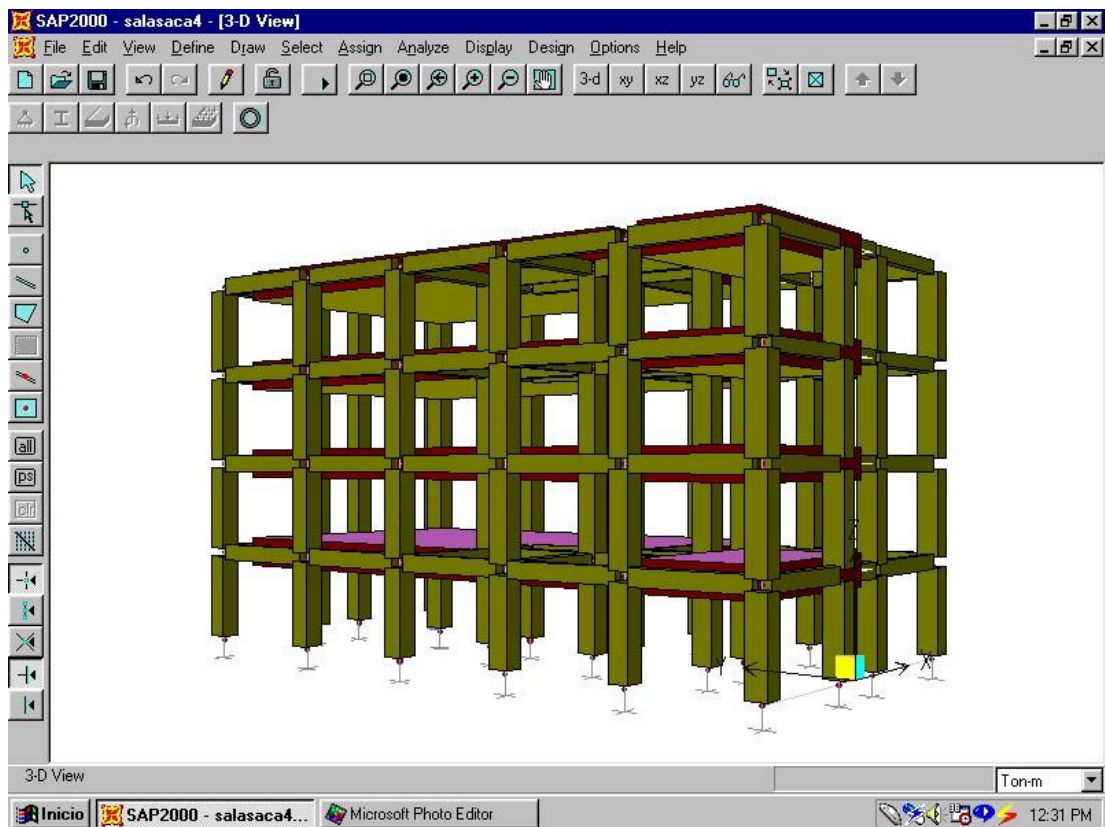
Pórtico espacial. Secciones de vigas, columnas y losas (perspectiva).
